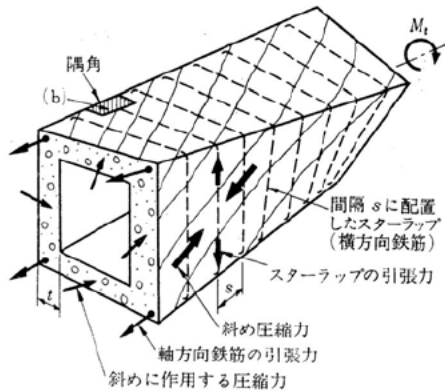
ねじりひび割れ発生後の鉄筋コンクリート部材断面における力の釣り合い¹⁴⁾
